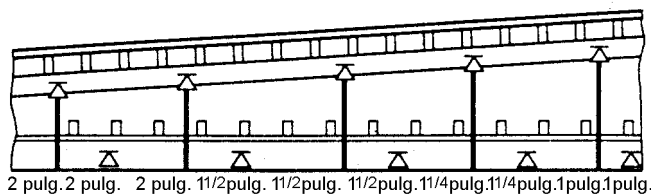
(a) Disposición de ramales que alimentan a rociadores por encima y por debajo de un cielorraso.
